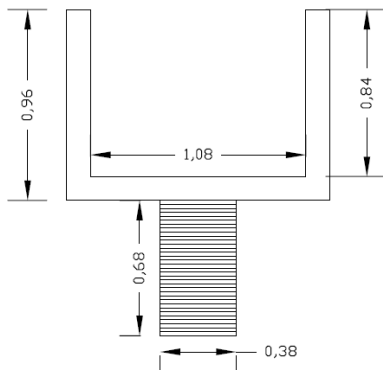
Vista de planta de toma para L-17 B finca UTN sede Guanacaste
